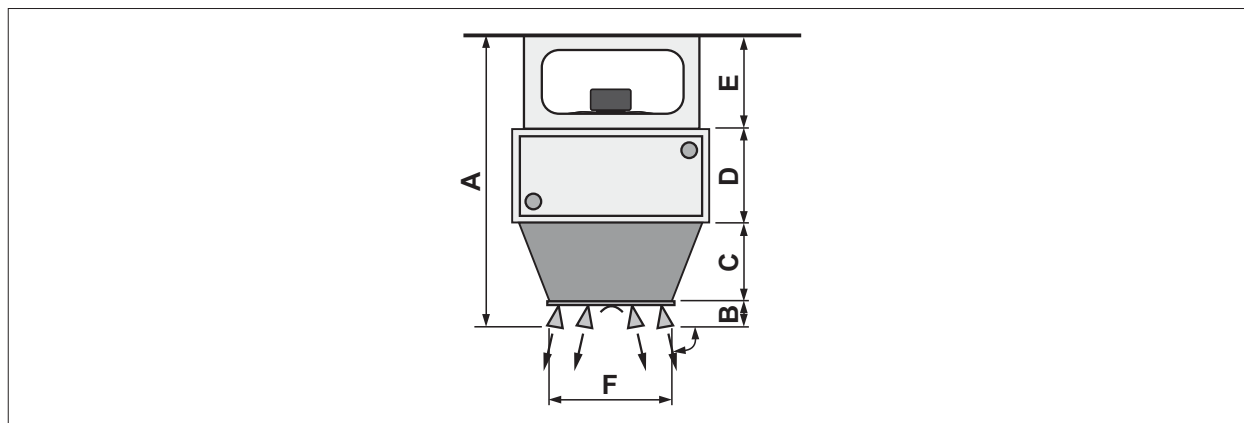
Размеры потолочного прибора с конической насадкой и индукционными жалюзи
